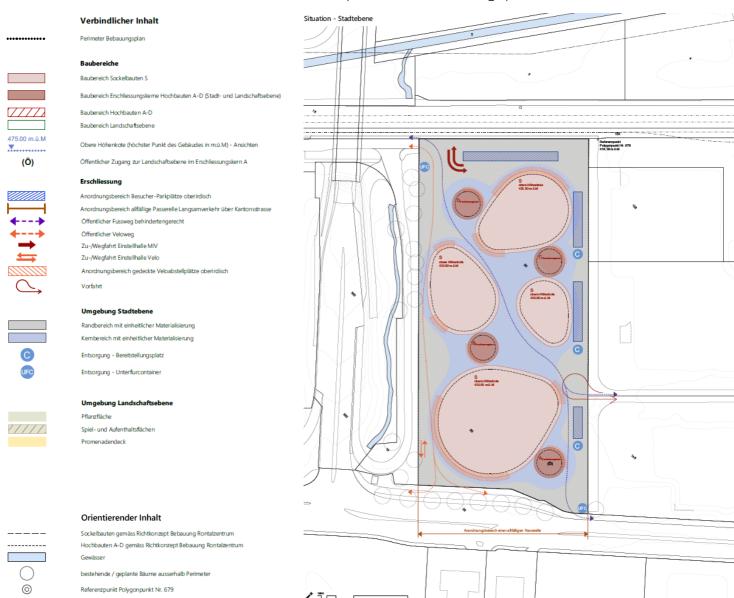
Situationsplan Stadtebene des Bebauungsplans Rontalzentrum, ohne Massstab
